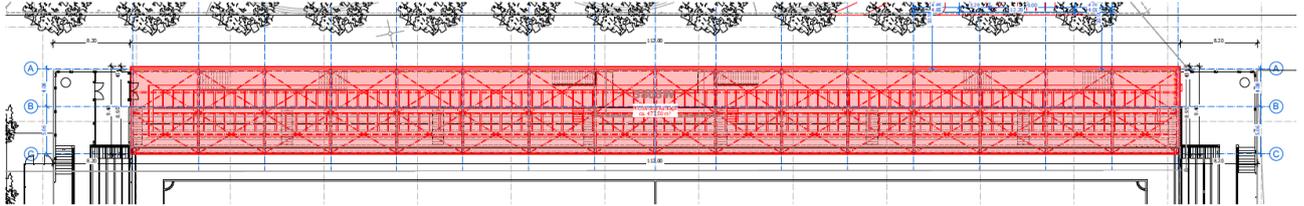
Grundriss Überdachung Aufsicht
